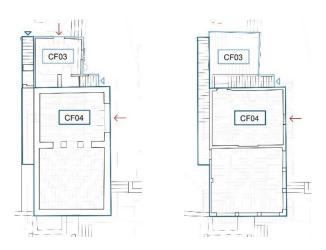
Edificio B - Suddivisione in corpi di fabbrica – da sinistra verso destra: pianta piano terra e primo
